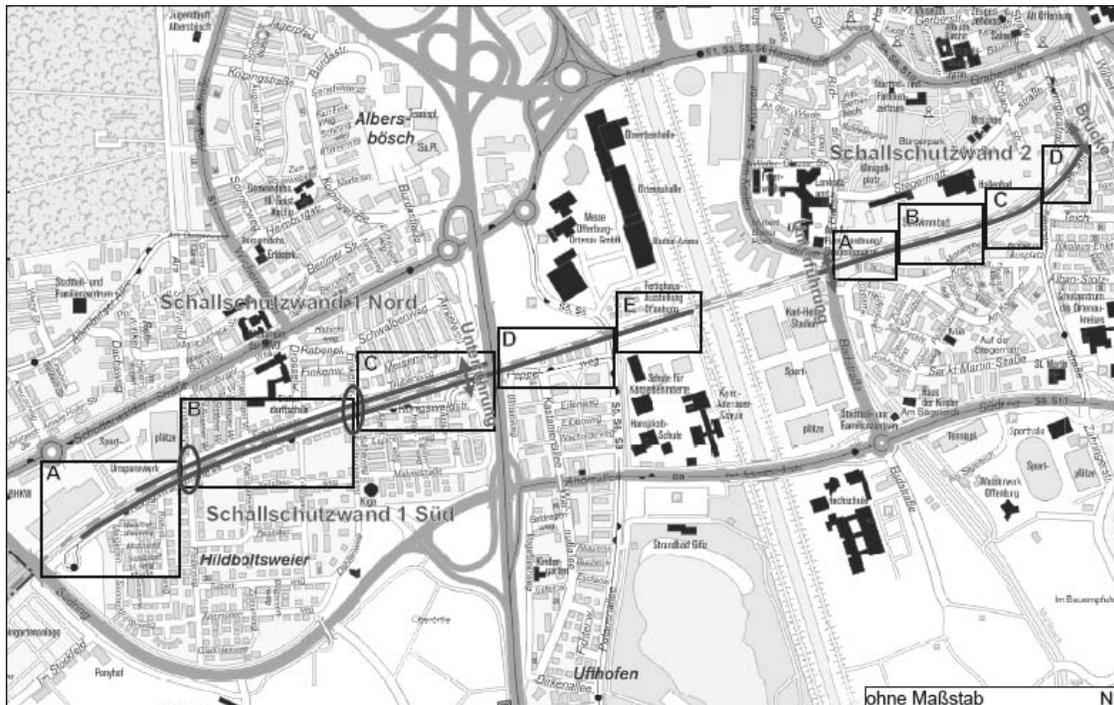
Planabschnitte der städtebaulichen Bewertung
